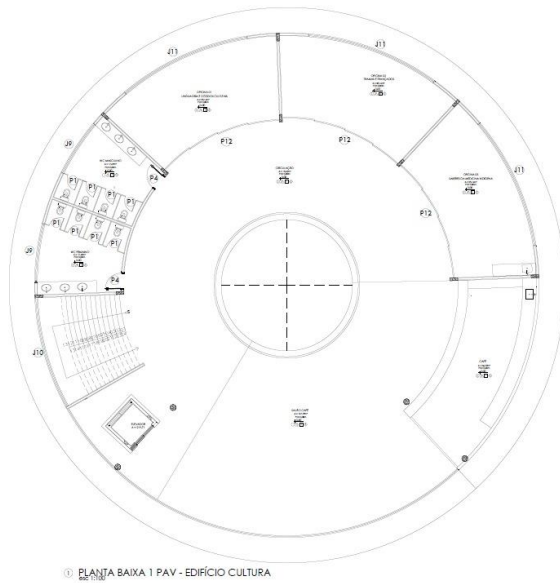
Planta Baixa – 1º Pav Ed. Cultura.
